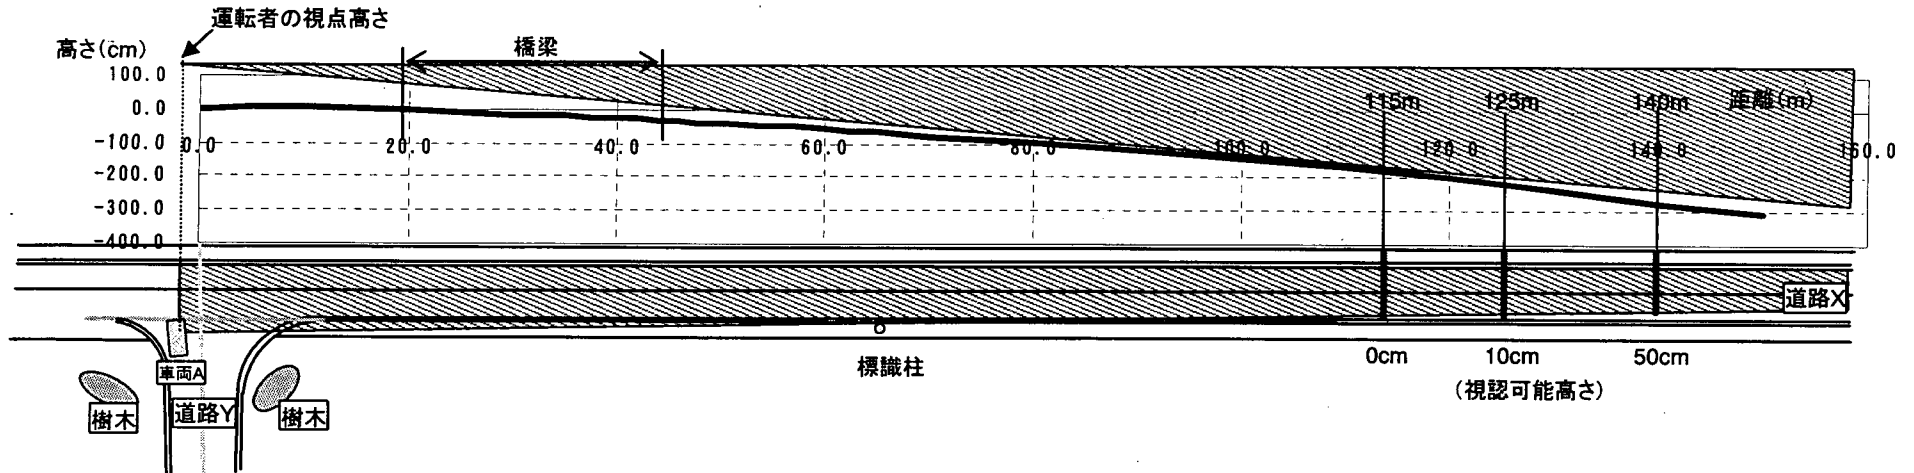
道路 X 進入直前位置からの視認範囲 (下：平面図, 上：縦断図)
